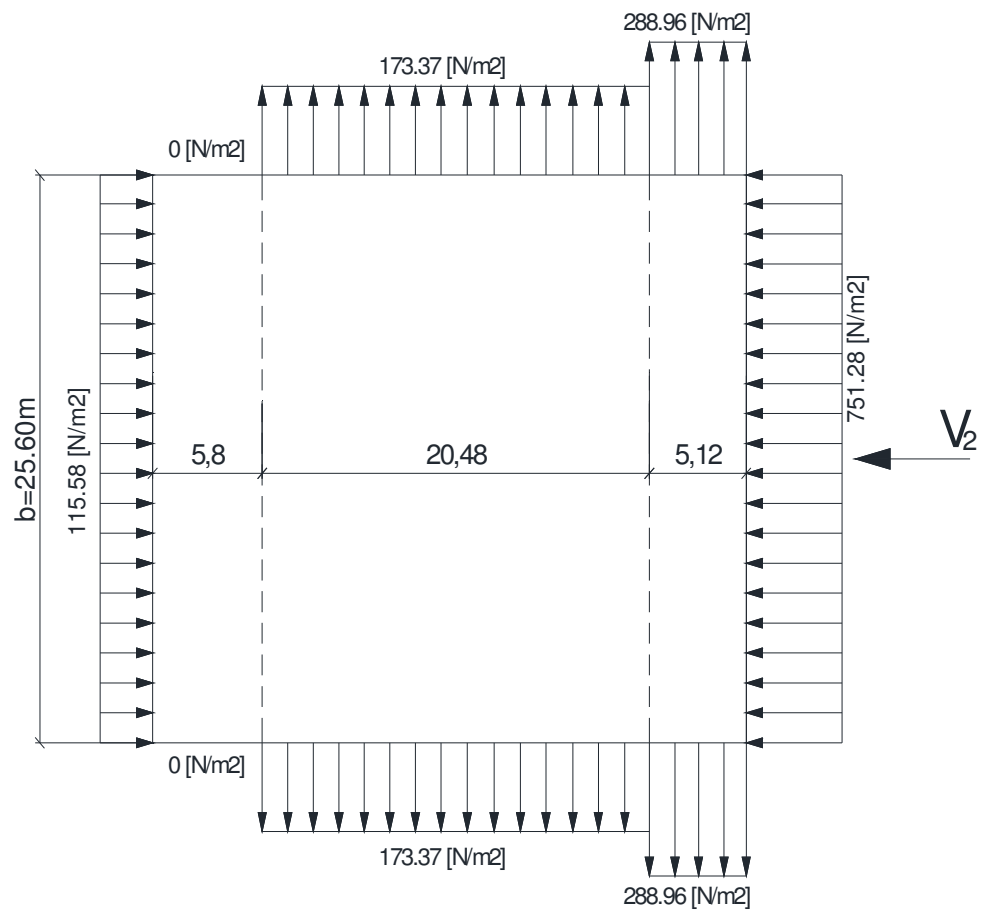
Pression du Vent – Parois verticales -Pignon façade Sud
